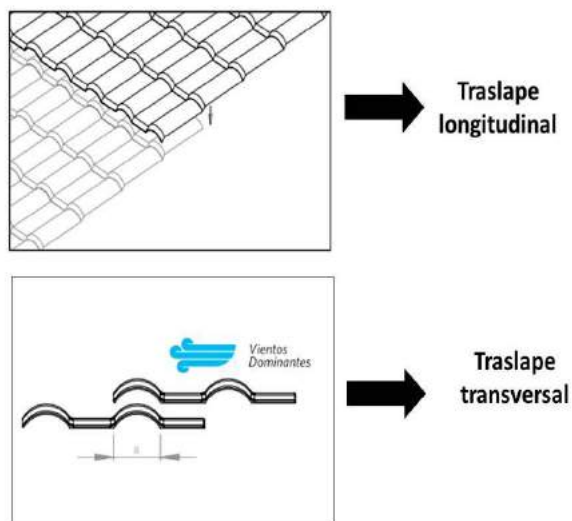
Traslape de las tejas.* En la imagen se aprecia el traslape de las tejas de manera longitudinal (a lo largo) y transversal (a lo ancho).
